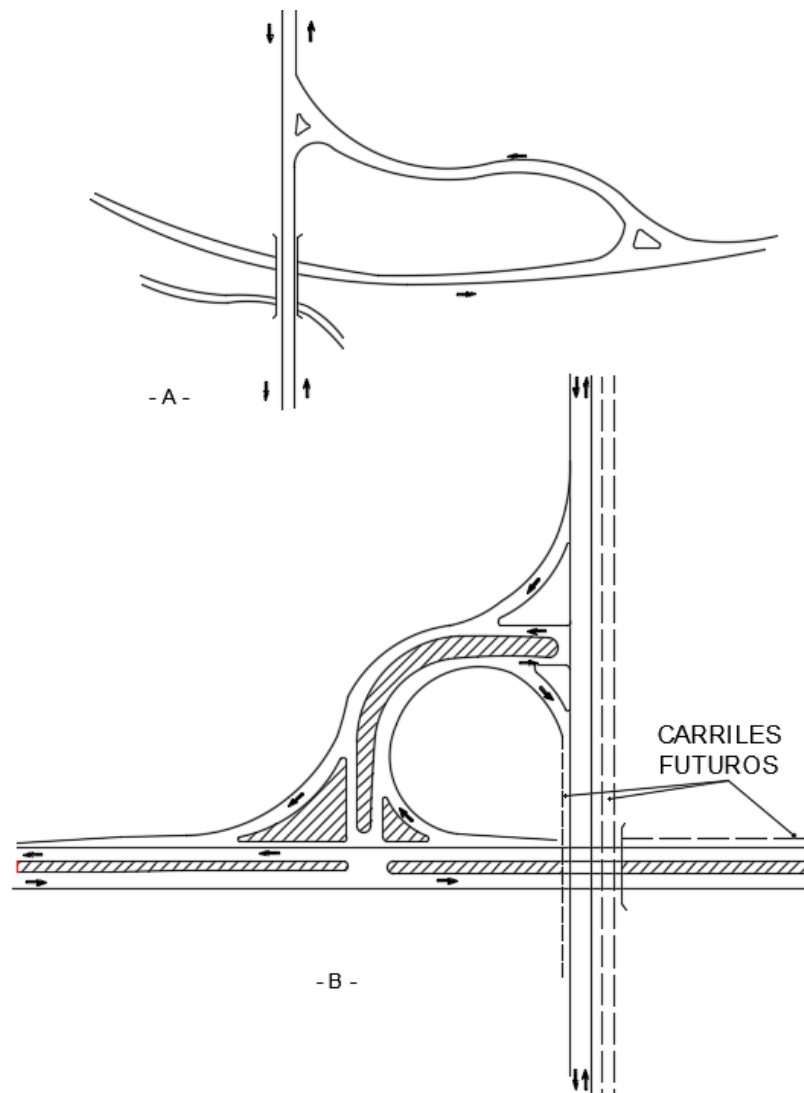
Intersección de cuatro ramas con rampas en un cuadrante
